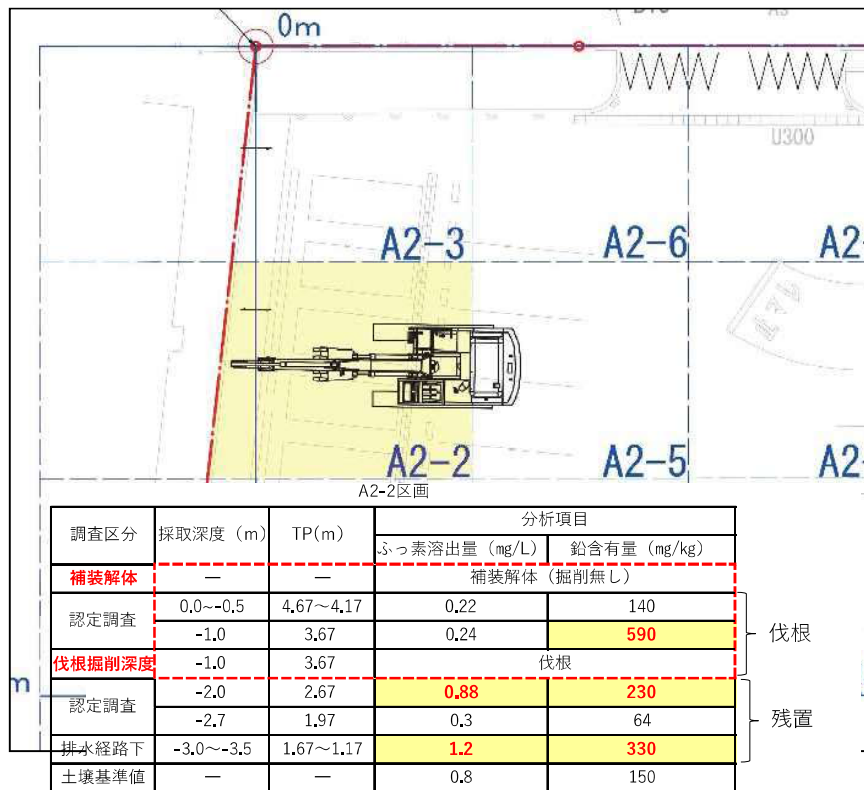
土地の形質の変更の施工方法を明らかにした平面図
